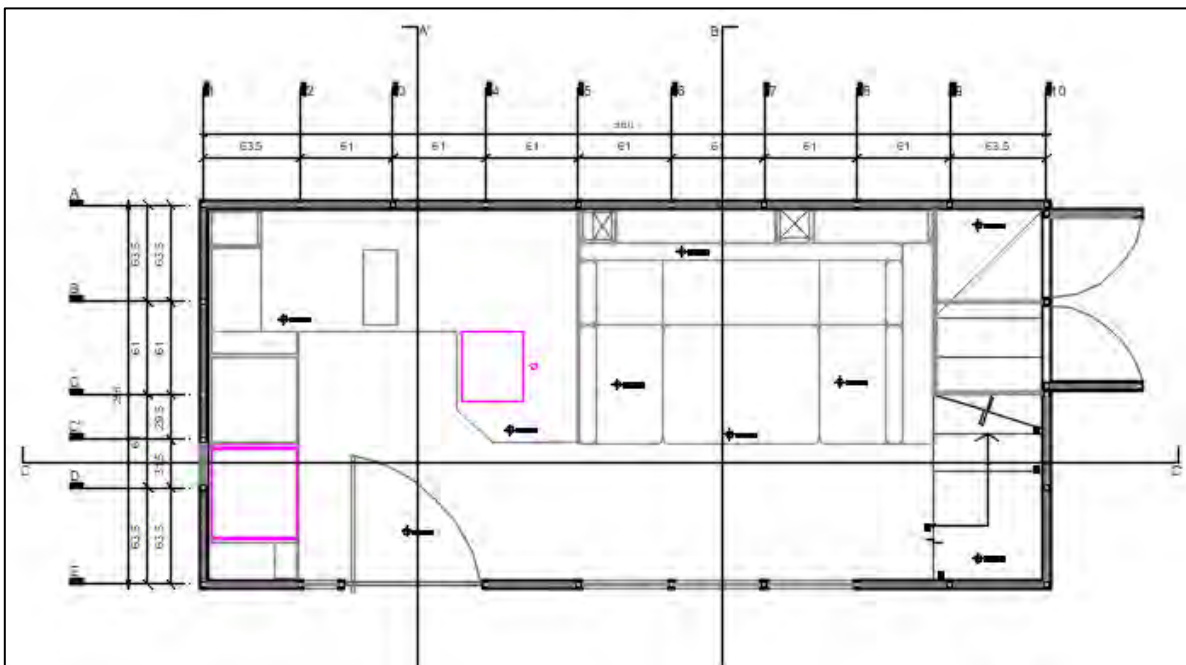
, Planta baja de VIS CASA (Tomado de VIS CASA, 2018)
